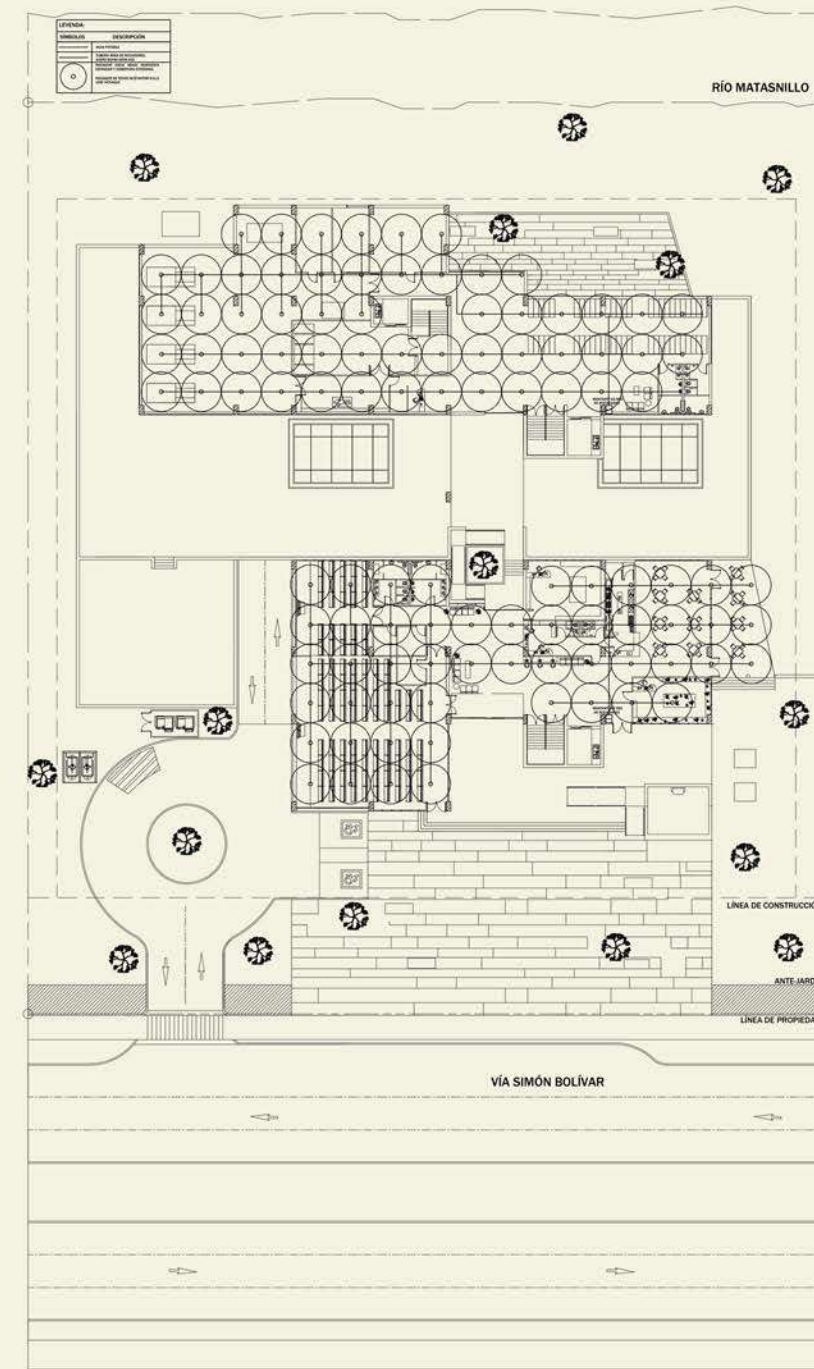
Plano de instalación de gas. (Escala para plano 2)
